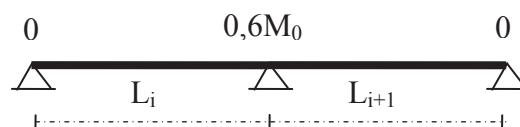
Schémas statique d'une poutrelle a deux travées
